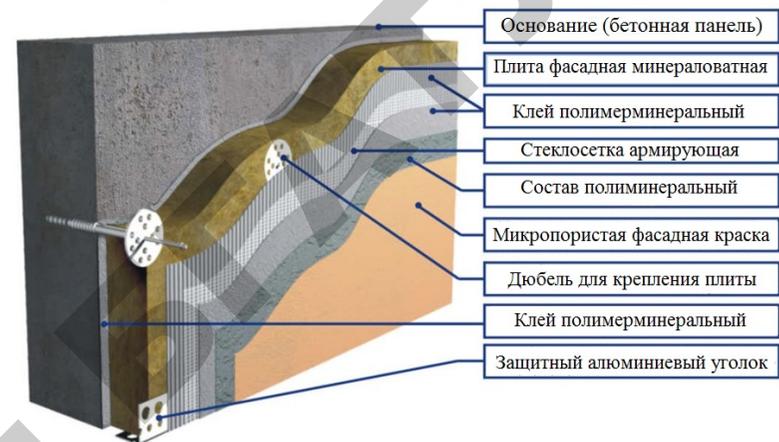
«Термошуба» типового здания: теплоизоляционный пирог с плитой фасадной минераловатной
